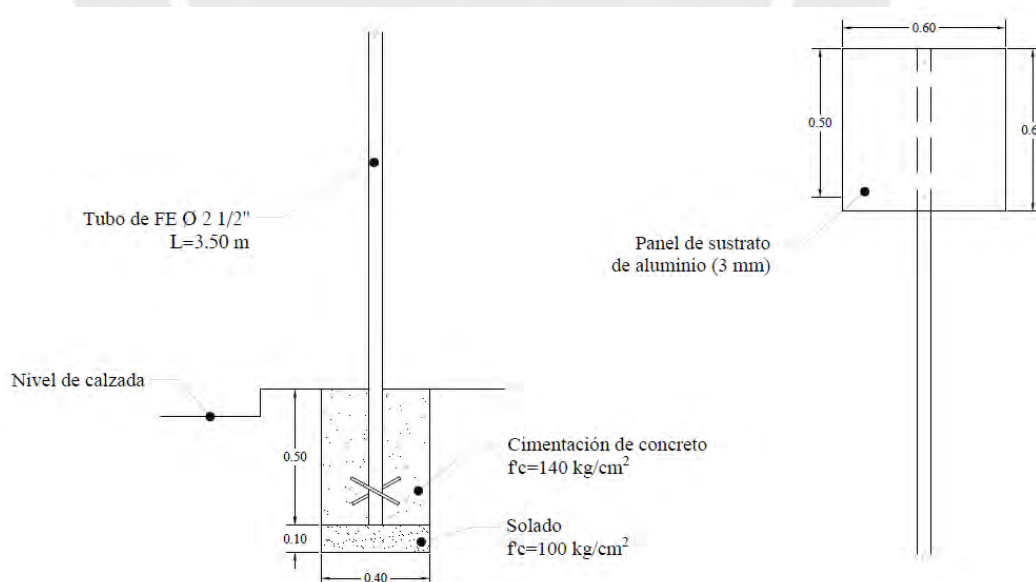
Detalles de las señalizaciones verticales. Fuente: Adaptado de MSI (2016)
